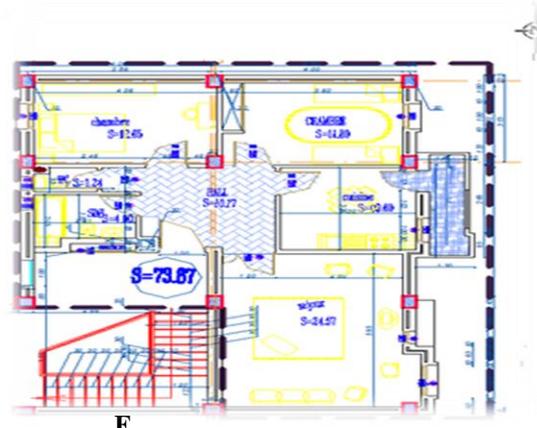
plan d'étage courant. Source : OPGI Tébessa
